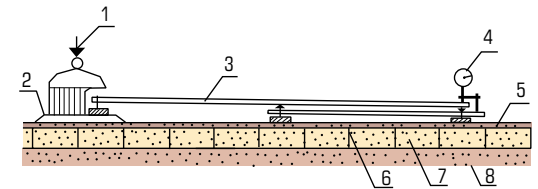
Прогибомер рычажного типа: 1 — нагрузка; 2 — жесткий штамп; 3 — рычаг прогибомера; 4 — индикатор часового типа; 5 — защитный слой над георешеткой; 6 — георешетка; 7 — песок — заполнитель; 8 — песок основания
